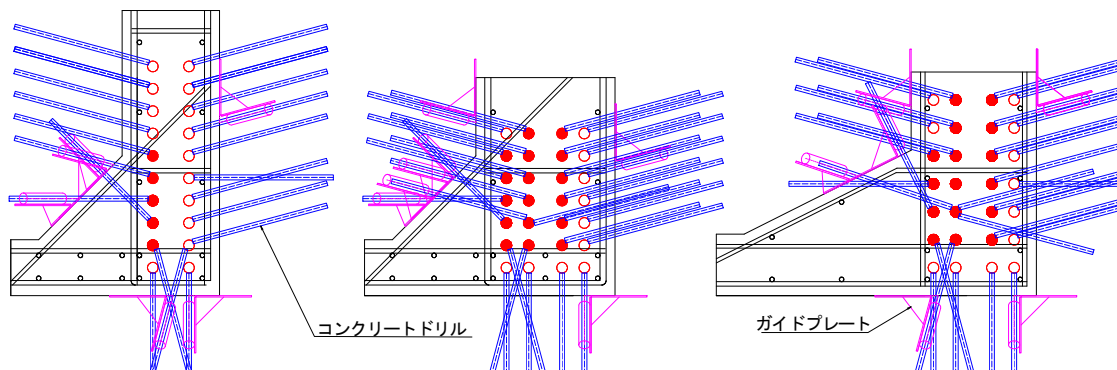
削孔方向例 (左: 試験体 No.1 中: 試験体 No.2 右: 試験体 No.3)
